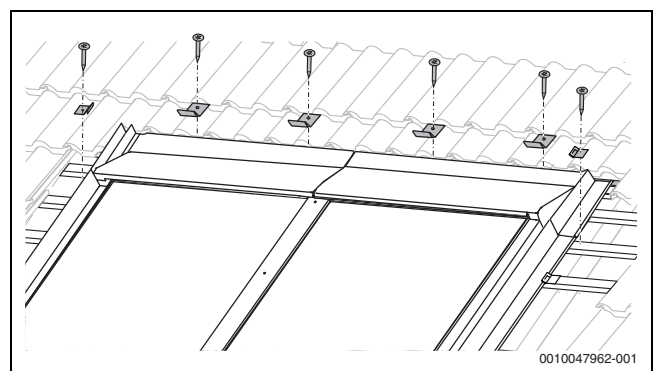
Obere Eindeckbleche mit Haftern fixieren
